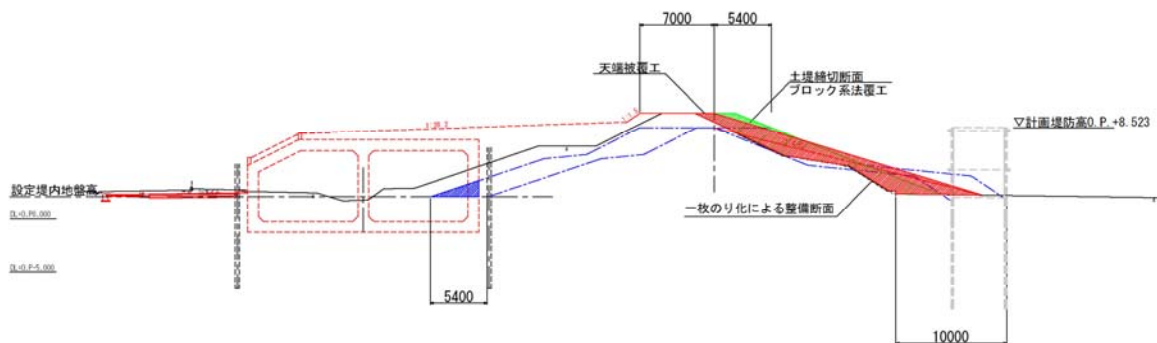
標準断面図（施工タイプ B）（次項へ続く）
